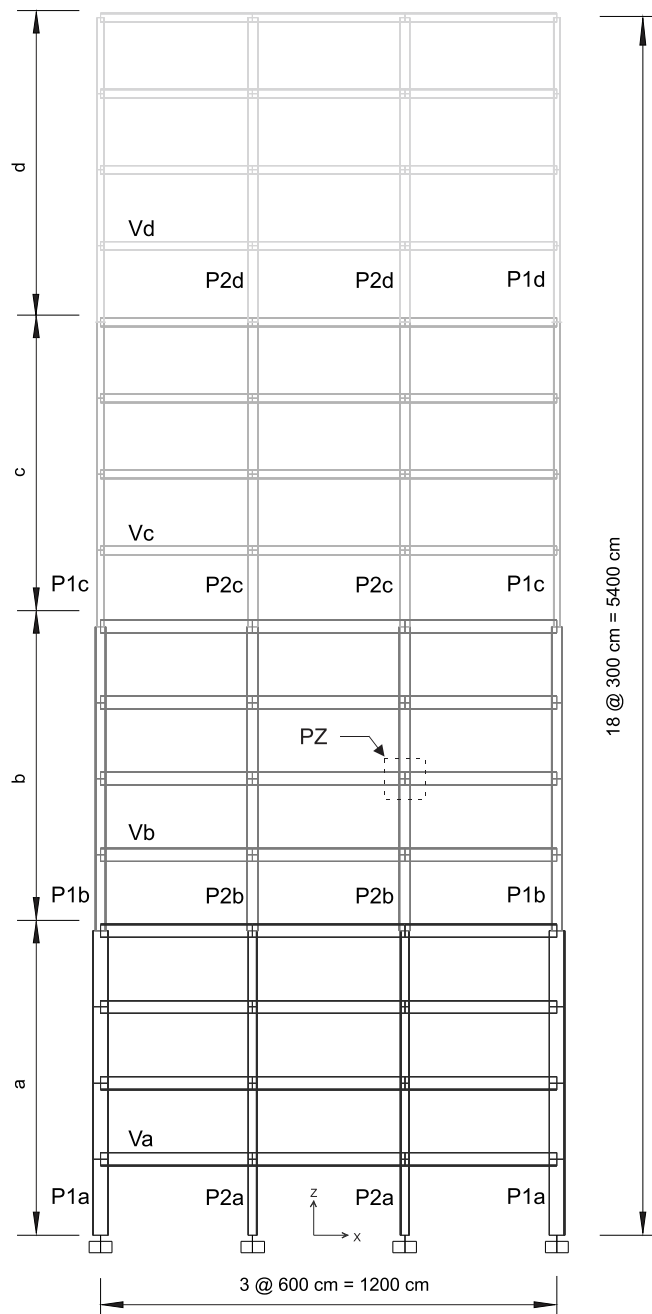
Caso 3 – Pórtico rígido de 18 pavimentos.
